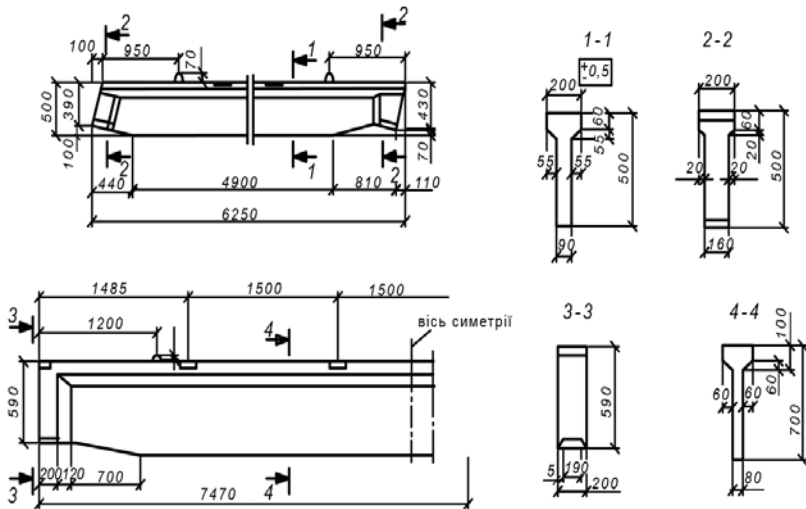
Залізобетонні одностатні балки покриття без попереднього напруження
